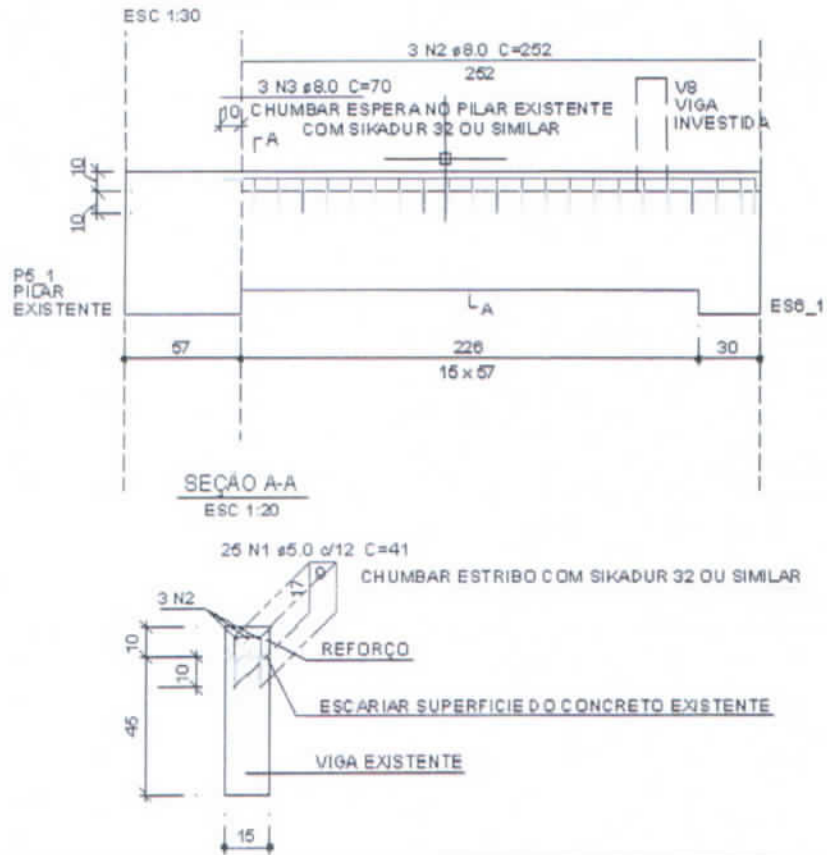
DETALHE DE REFORÇO DA VIGA VBA_13
